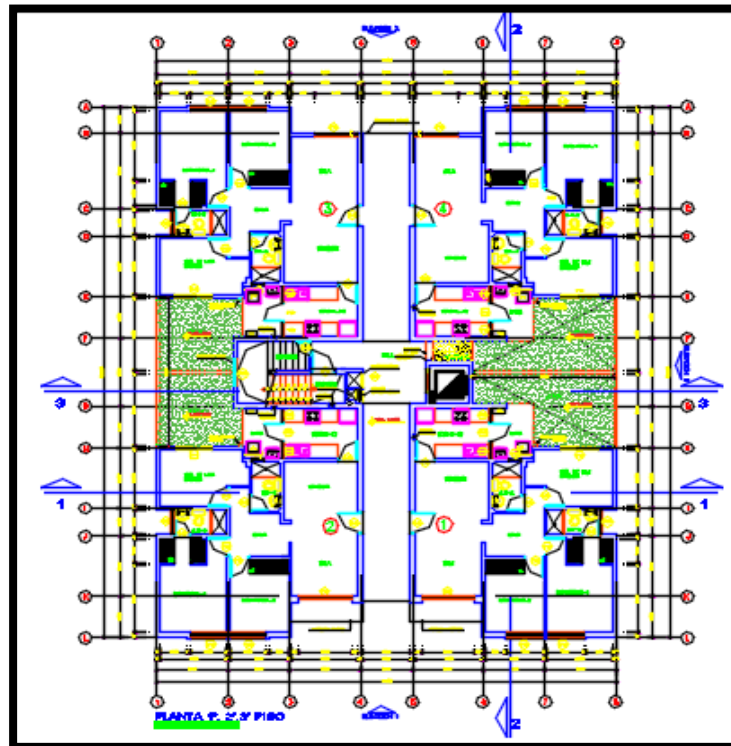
Planta del Proyecto “Edificio residencial alameda colonial”.
